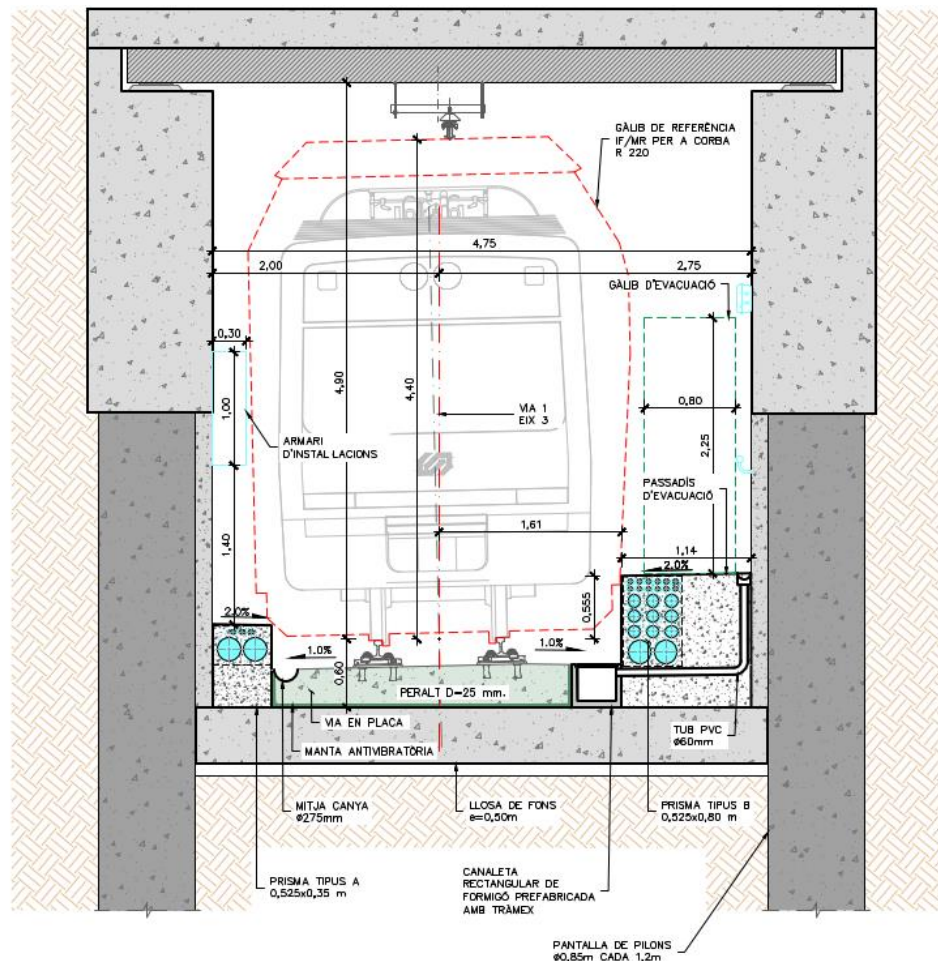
Secció tipus túnel amb coberta a 4,90 metres.
